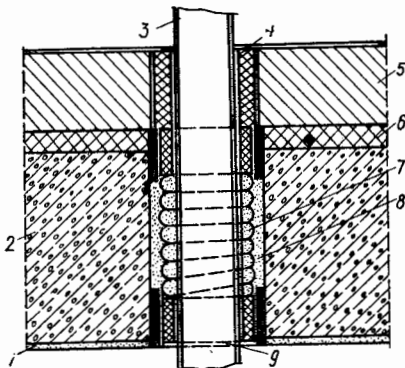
Звукоизоляция трубопровода в перекрытии:
